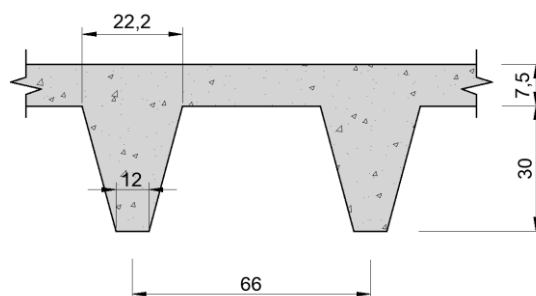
Projeto B1 - Seção da laje nervurada (dimensões em cm).
